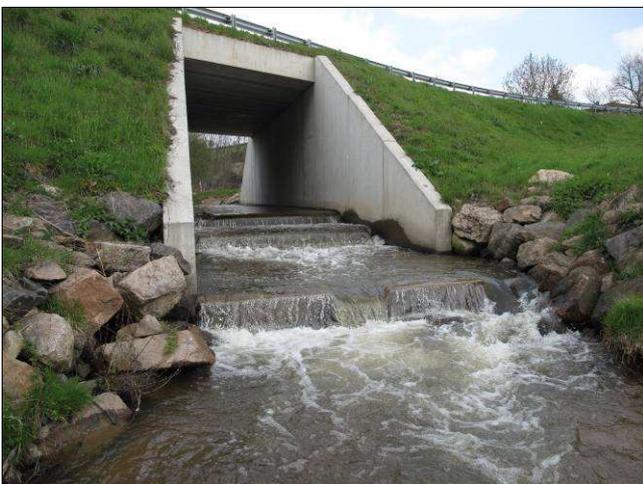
exemple d'un seuil pouvant être facilement arasé (seuil sur le ruisseau de Fissy à Lugny)
